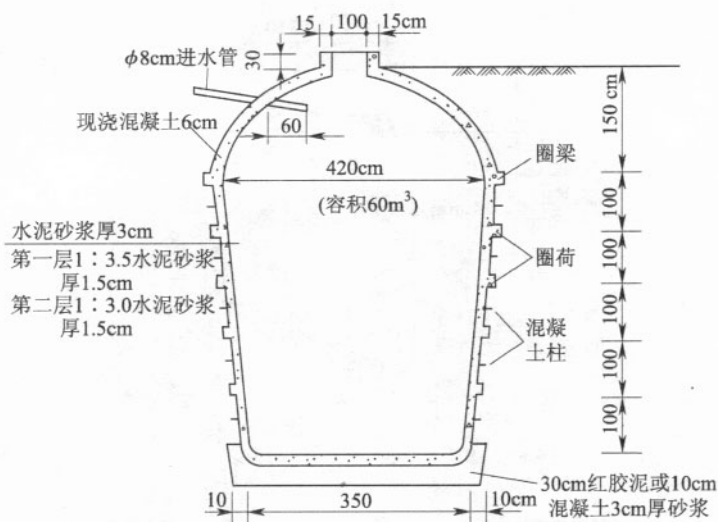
混凝土顶拱和带砂浆铆钉的水泥砂浆薄壁水窖剖面(单位:cm)
